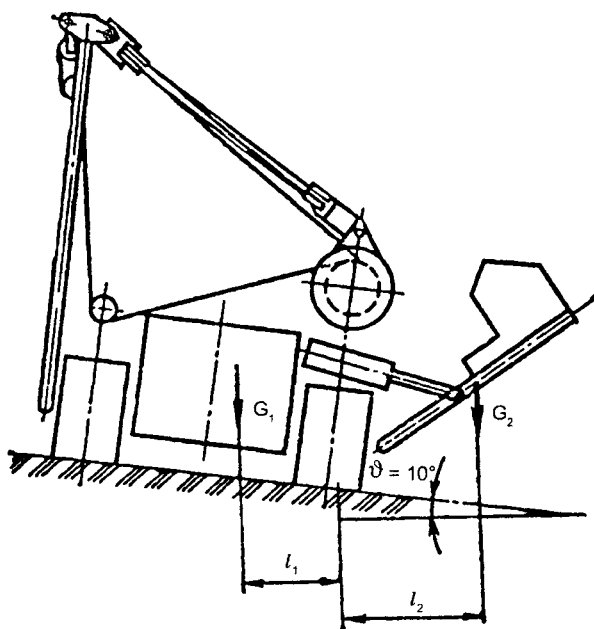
Схема к расчету собственной устойчивости трубоукладчика
